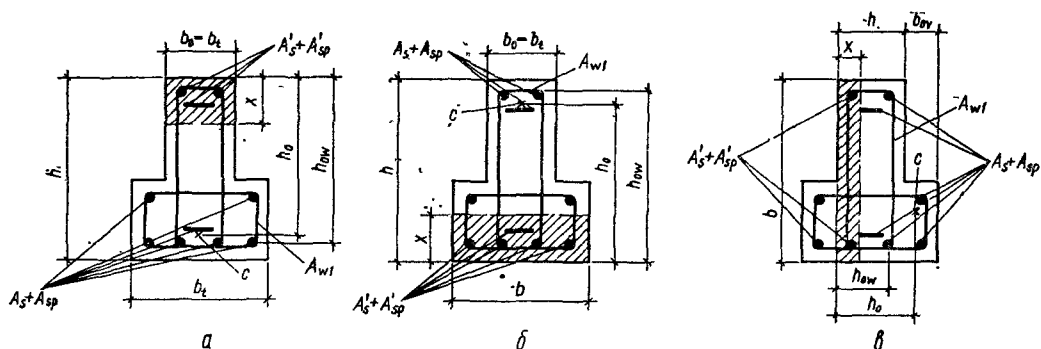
Схемы расположения сжатой зоны в пространственном сечении железобетонного элемента таврового сечения, работающего на кручение с изгибом:
